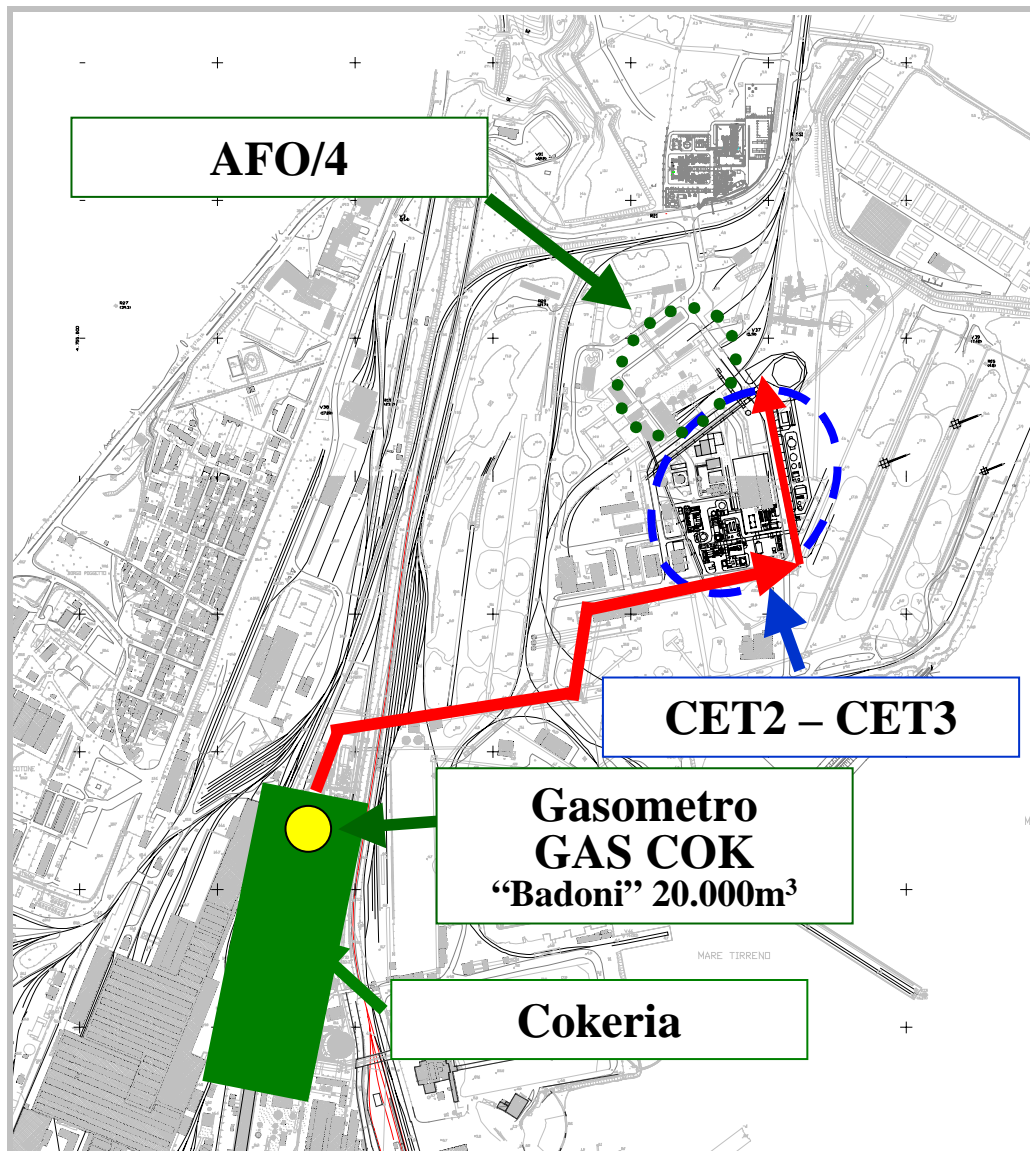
Planimetria schematica della rete di distribuzione del Gas di Cokeria
